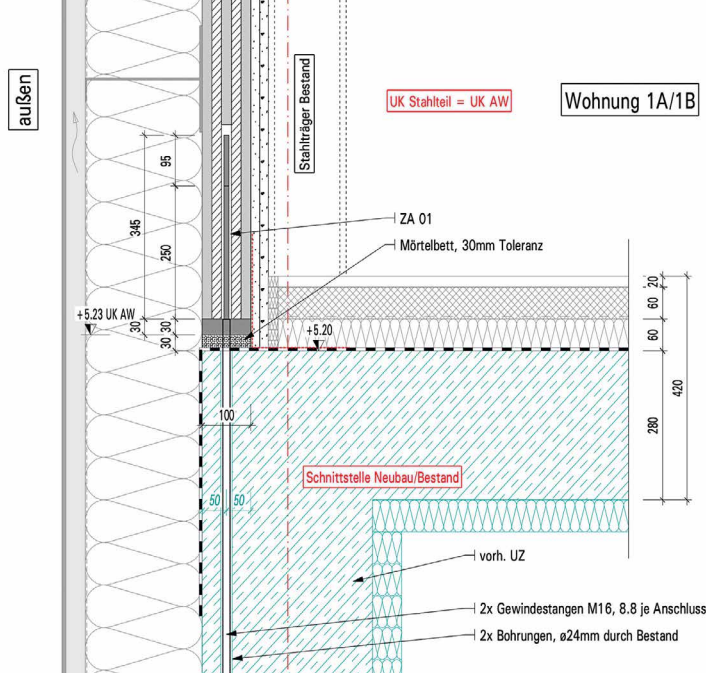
Detail zugfeste Verankerung der Außenwand mit Gewindestangen zuzüglich eines Halfen-Muffenstabs (© Pirmin Jung Ingenieure)
